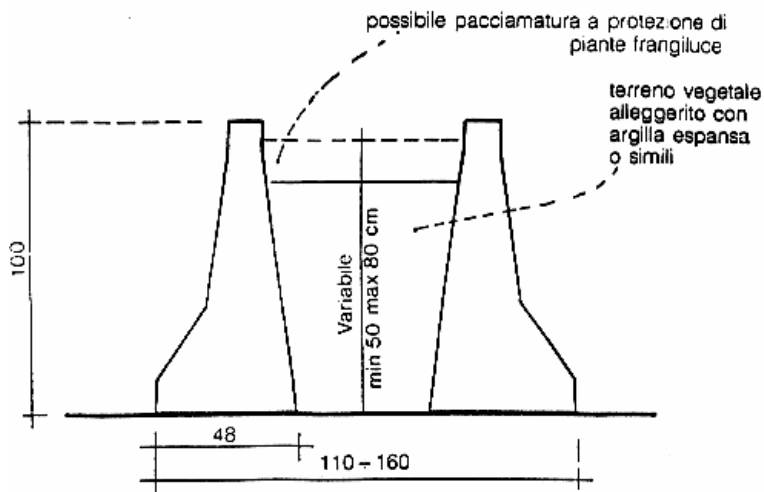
Barriera in calcestruzzo bifilare simmetrica per spartitraffico stretto.
